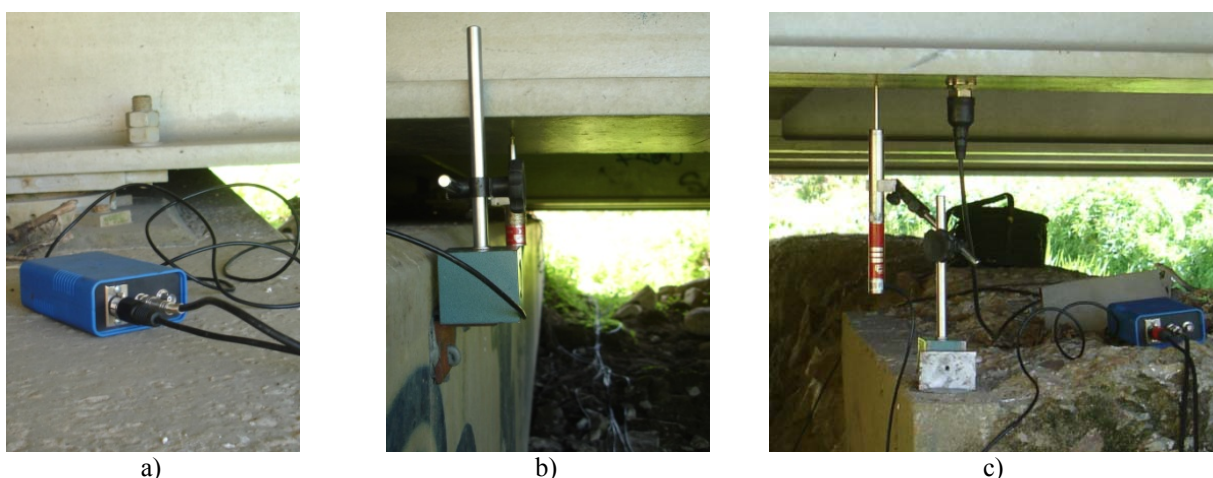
Medição de deslocamentos através de LVDTs: a) caixa de derivação das ligações do LVDT; b) LVDT junto ao apoio (sensor D1); c) LVDT na viga longitudinal do tabuleiro, entre 1/3 e 1/4 do vão (sensor D2).
